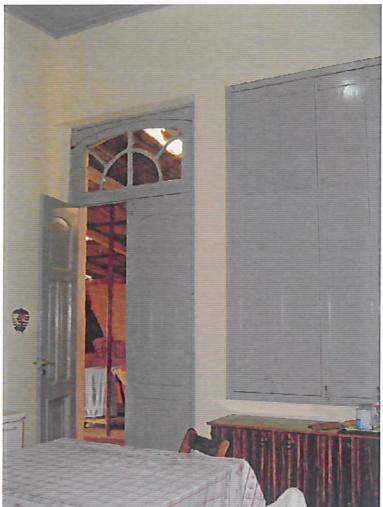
Esquadrias em madeira. Foto 10: Forro em madeira tipo paulista.
